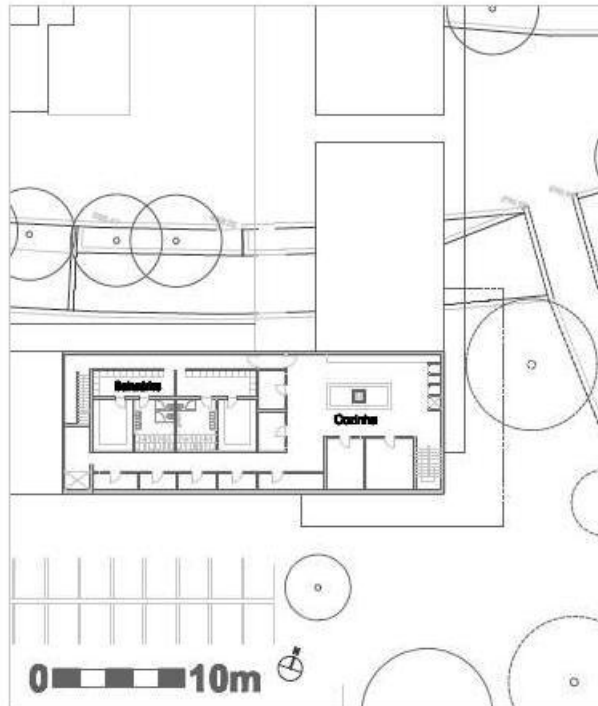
Planta da Proposta Piso -1. (Ver Anexo IV)
